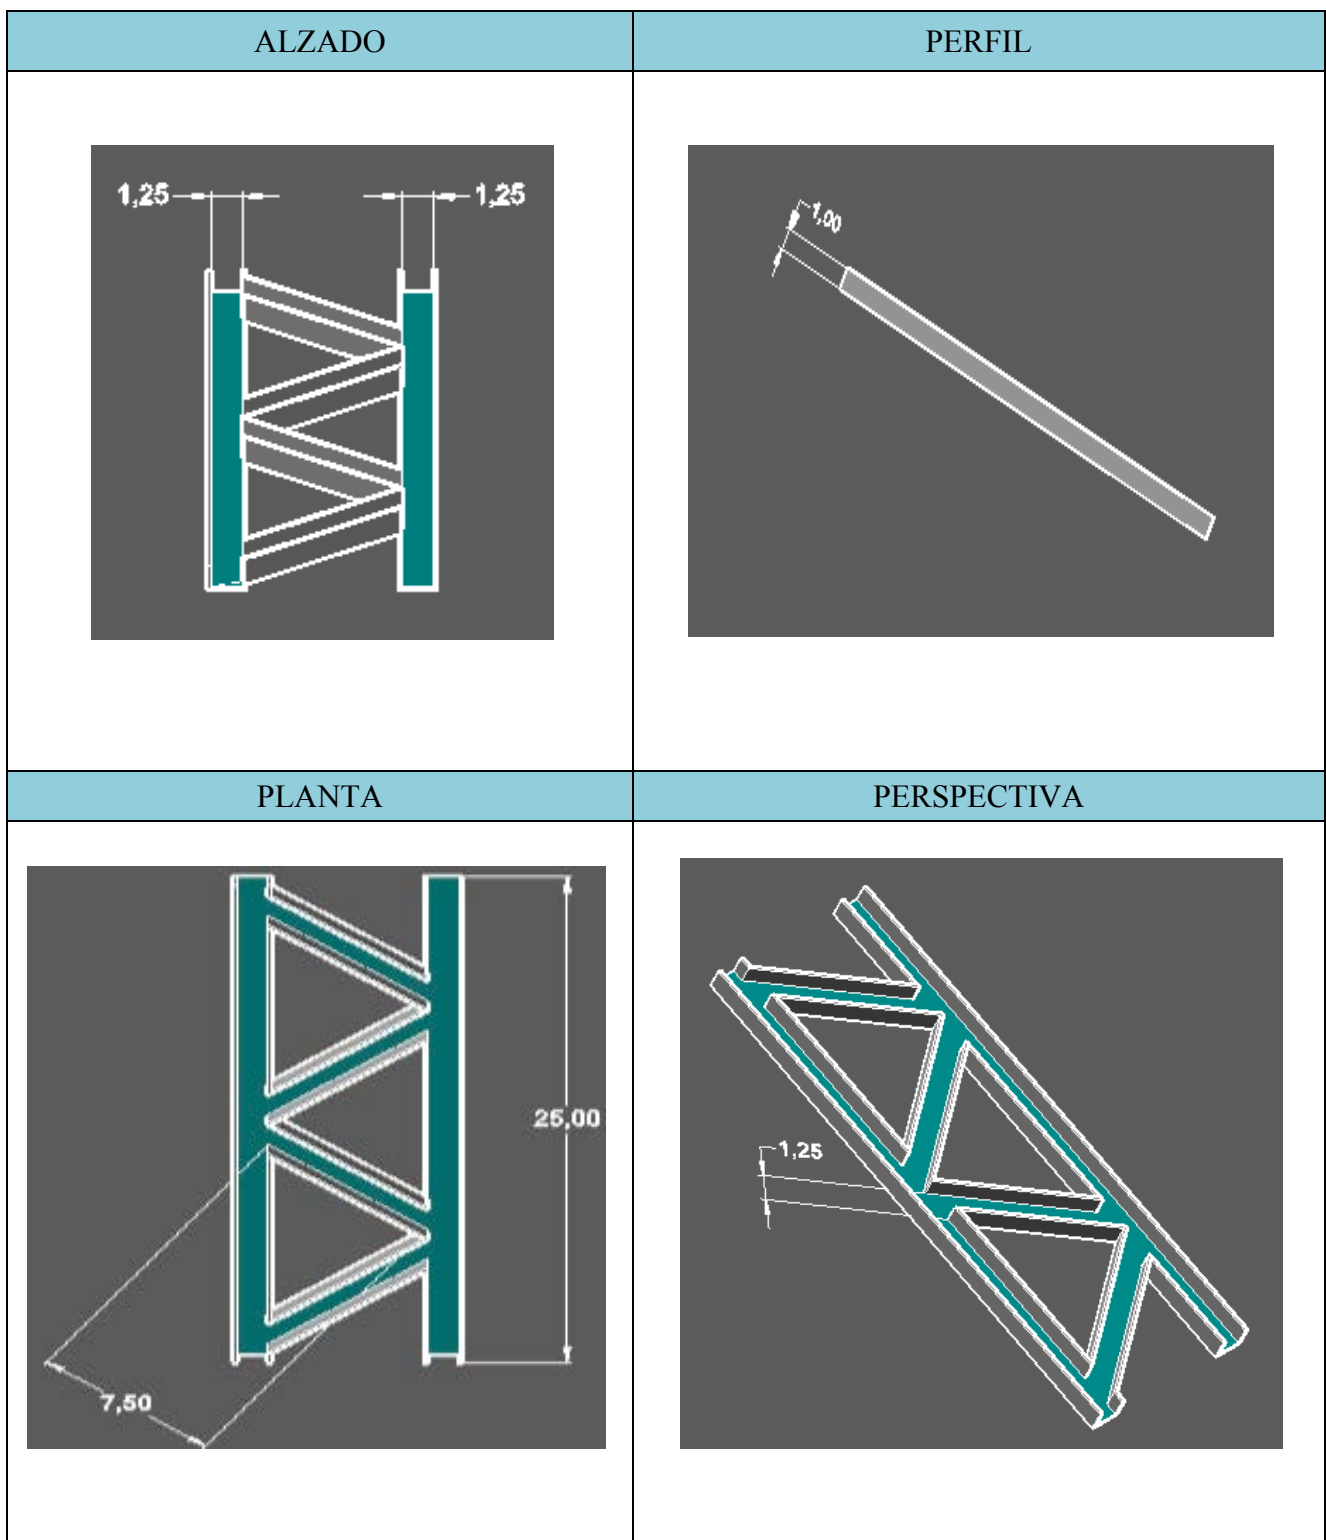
Ficha técnica (alzado, perfil, planta y vista en perspectiva SO) del drenaje ramificado (alternativa D).
